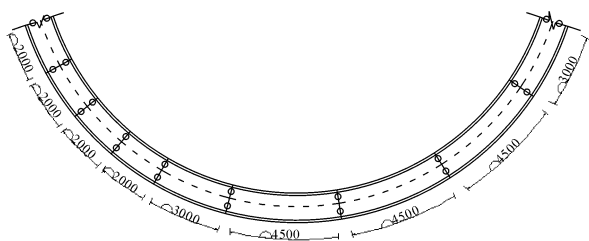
曲线钢箱梁桥平面布置图(单位:cm)
